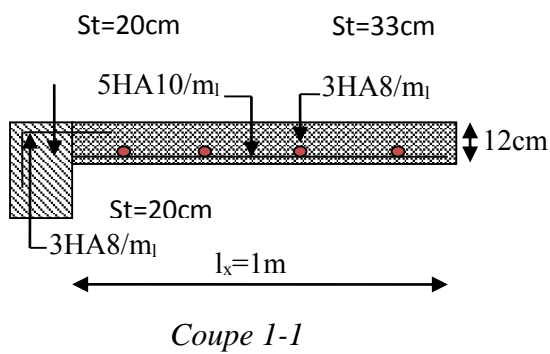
Schéma de ferrailage de la dalle sur 3 appuis.
